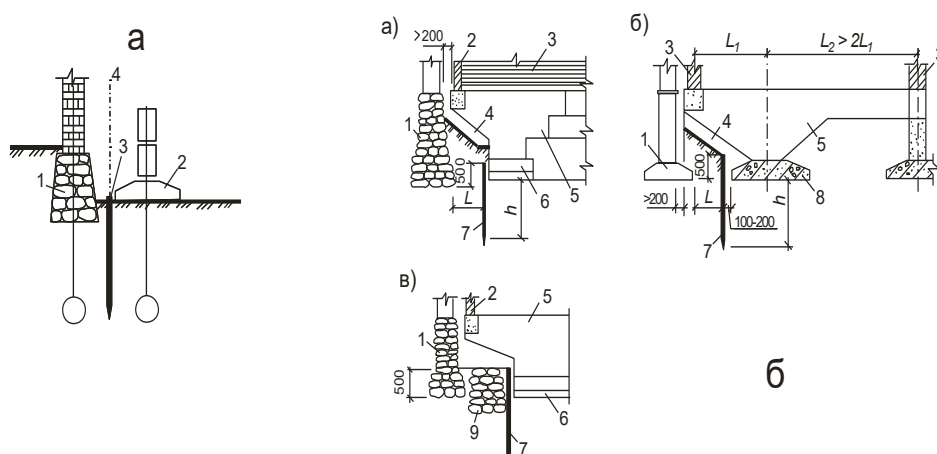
Примикання до існуючих фундаментів нових фундаментів неглибокого закладання: *а* – примикання з відступом: 1 – раніше влаштований фундамент (бутовий); 2 – збірний залізобетонний фундамент більш пізнішого будівництва; 3 – технологічний шпунт (дерево); 4 – ось осадочного шва; *б* – консольне примикання: *а*) – з поздовжніми несучими стінами; *б*) – з поперечними несучими стінами; *в*) – із зберіганням фундаменту зруйнованого будинку; 1 – існуючий фундамент; 2 – огорожуюча стіна; 3 – несуча стіна; 4 – зазор; 5 – монолітна частина стіни фундаменту із консоллю; 6 – розширення підшви фундаменту; 7 – шпунт; 8 – поперечний стрічковий фундамент; 9 – частина старого будинку, що зберігається
